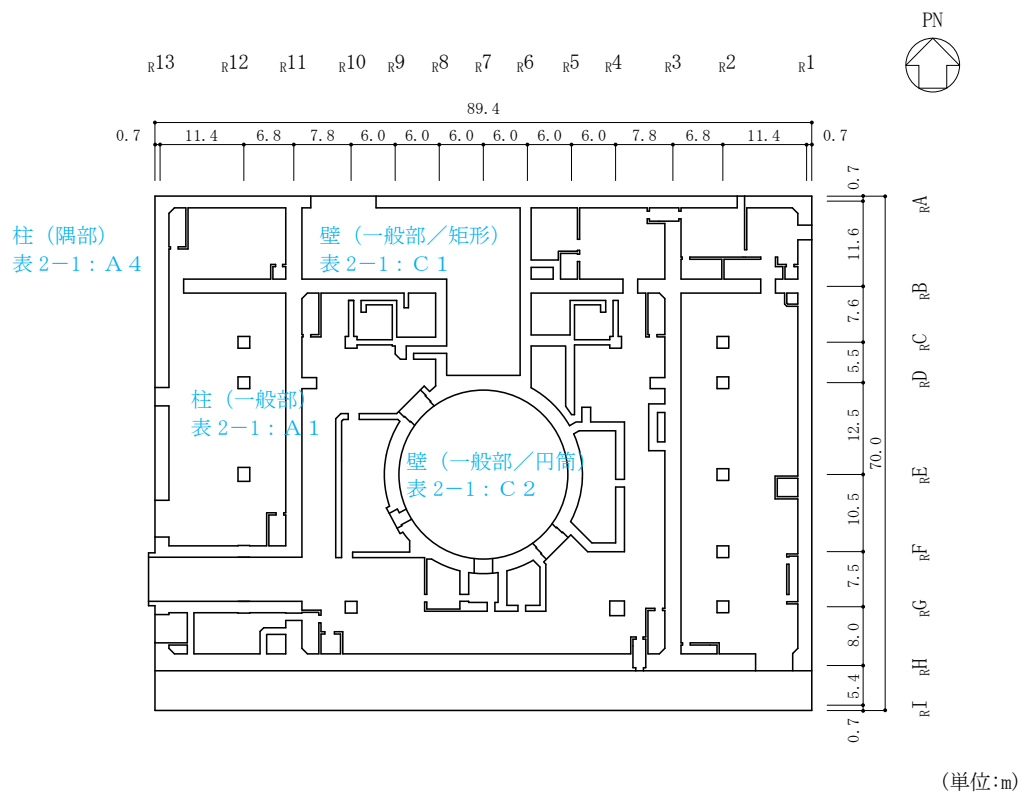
(3) 原子炉建物の概略平面図 (EL 15.3m)
